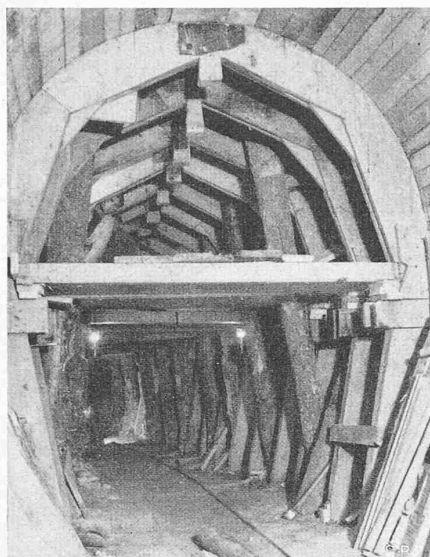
Holzeinbau und Betonchalung in der Triasstrecke des Zulaufstollens
